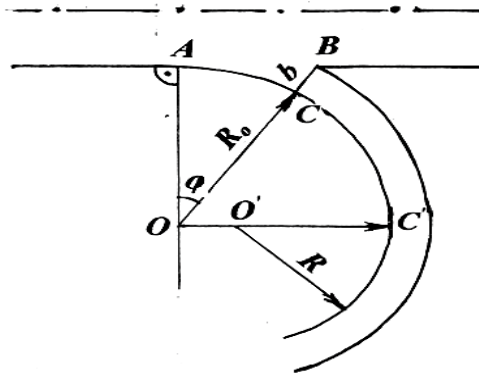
Розрахункова схема вписування поздовжнього похилу на з'їзді
